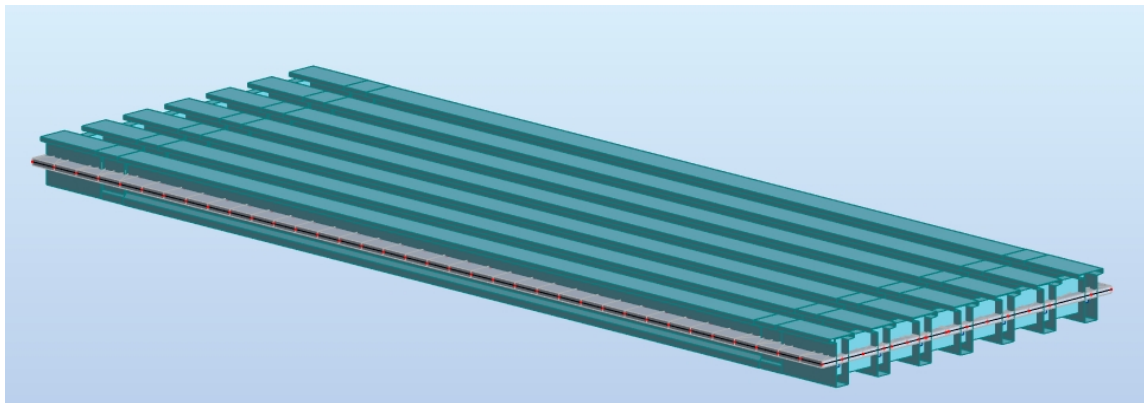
Définition des poutres, dalle, entretoise, appui
